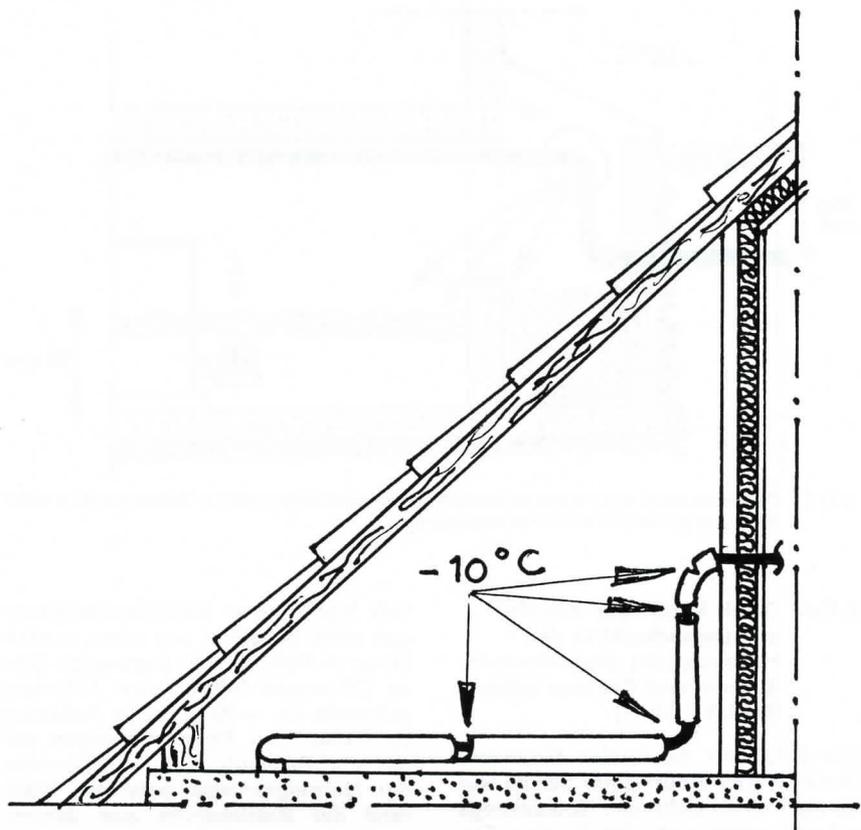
Unvollständige Rohrisolierung einer Wasserleitung hinter einer Drempe wand.
